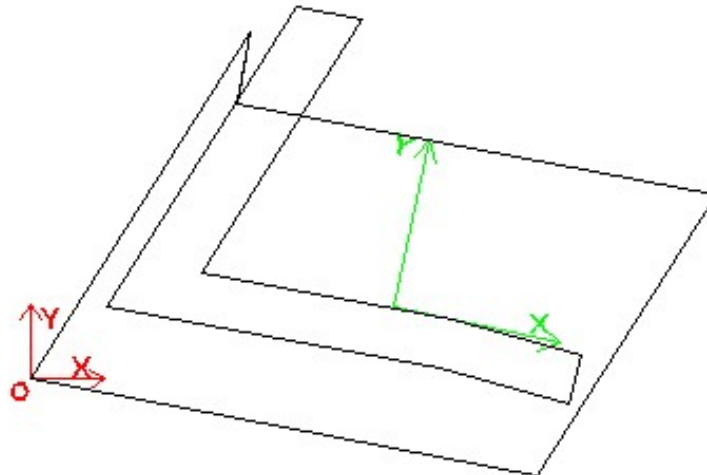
sistema di riferimento globale della fondazione e locale del muro d'ala
